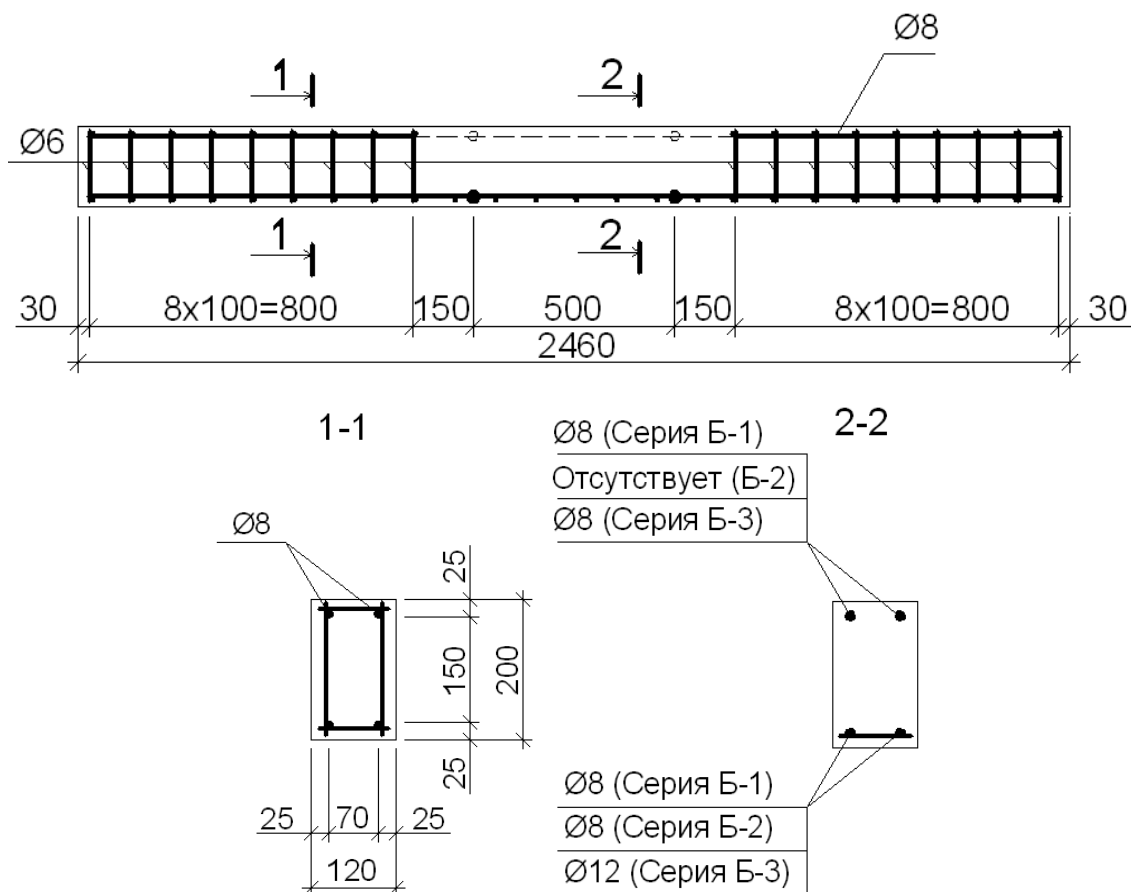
Проектные размеры и армирование опытных железобетонных образцов-балок по сериям Б1, Б2 и Б3
